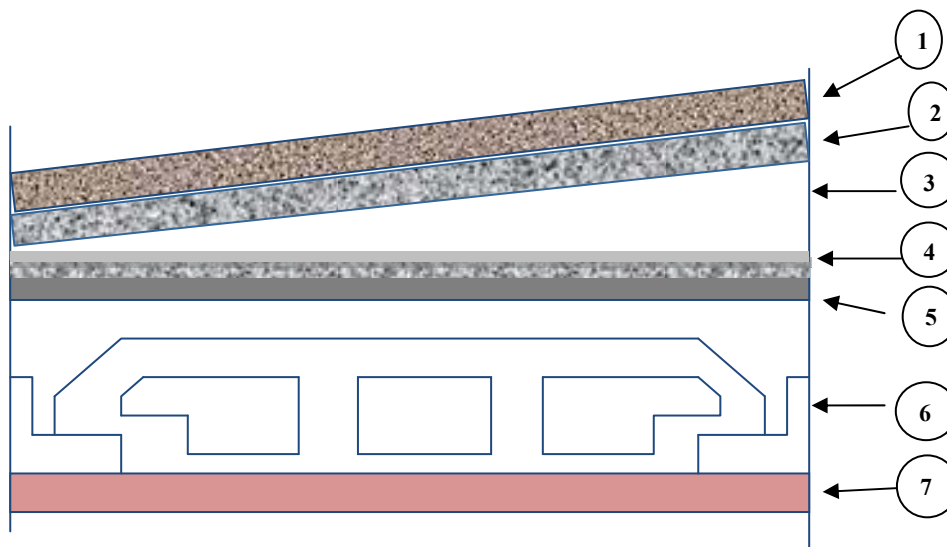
les défèrent couches de plancher terrasse inaccessible
